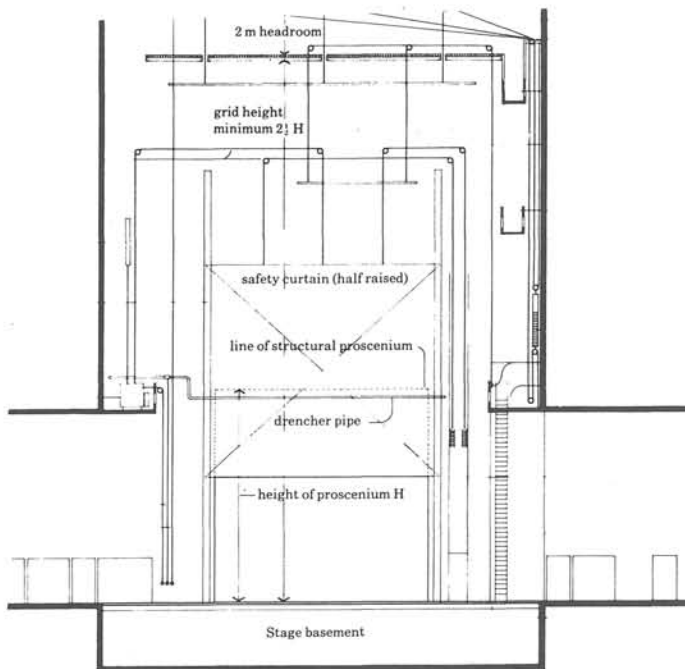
Alzado trasero del «telar» sobre el escenario.
